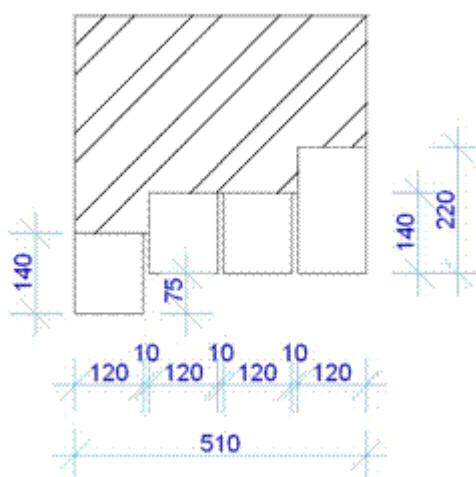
Схема установки перемычек над проемами в наружных несущих кирпичных стенах.
